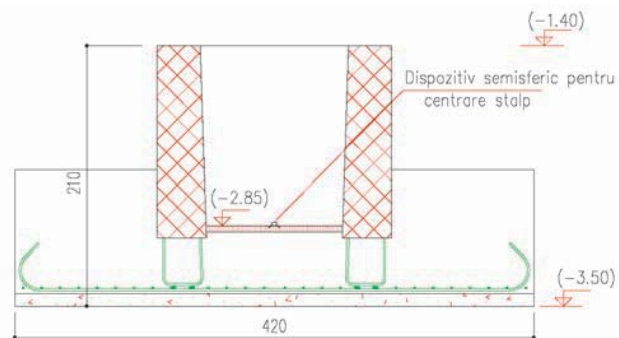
Fundațiile din beton monolit și cuzineți prefabricați
